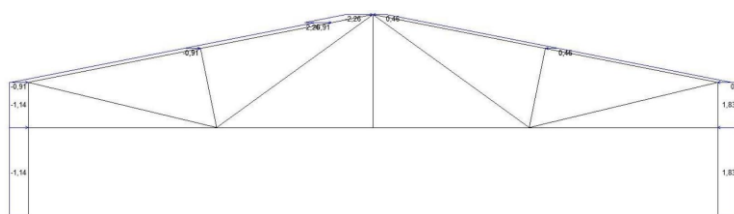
Вітрове навантаження на ферму та колону, варіант 2
